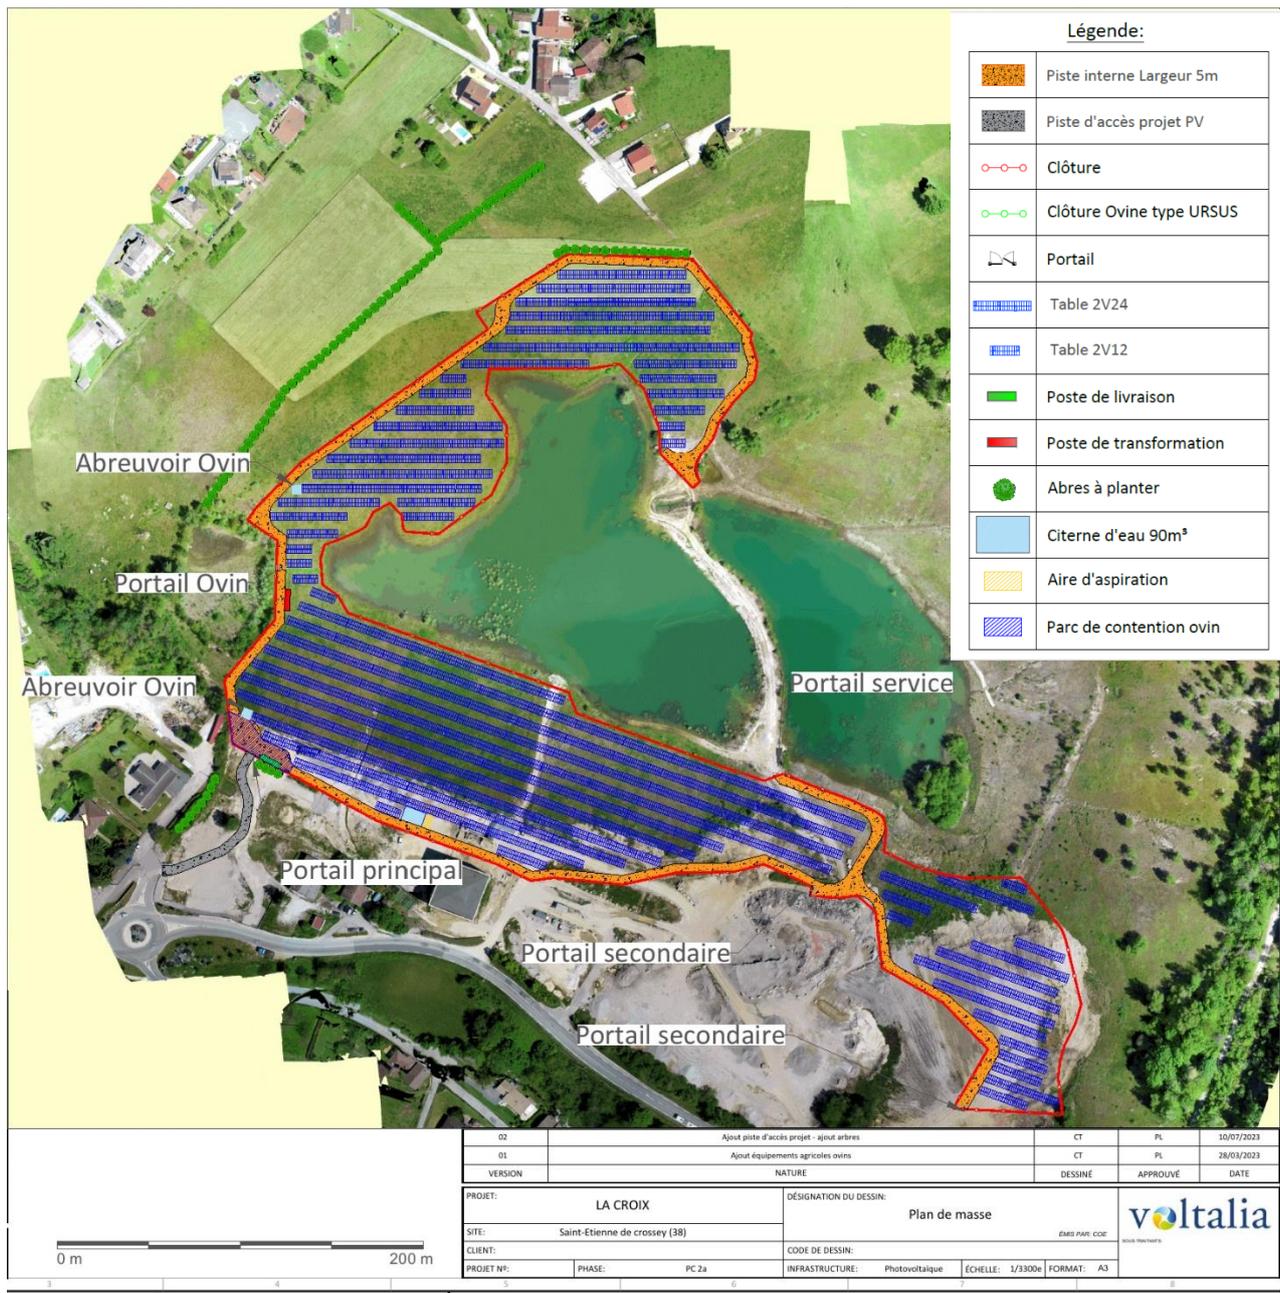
Plan masse du projet - Dossier du permis de construire — CLT architectes – 10/07/2023
